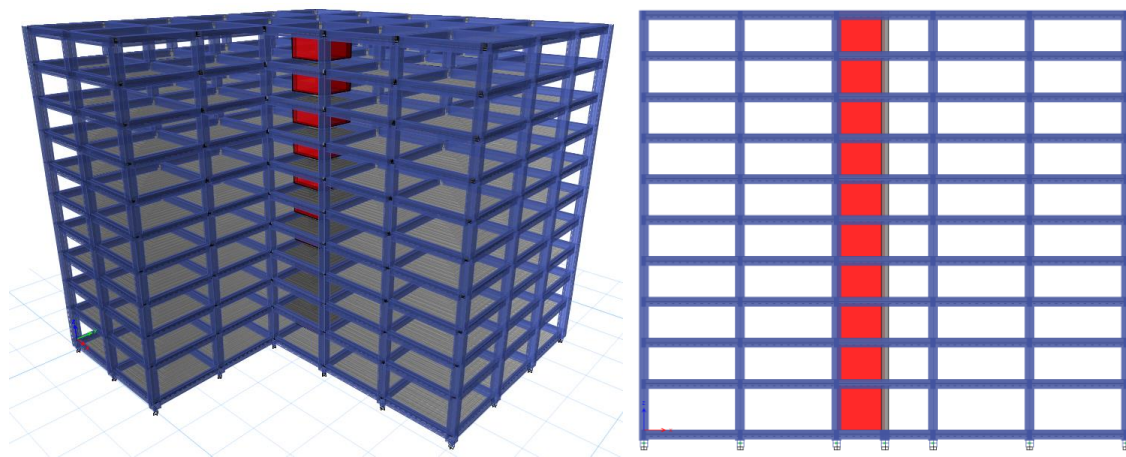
Vista 3D y elevación longitudinal del modelo base aislada.
